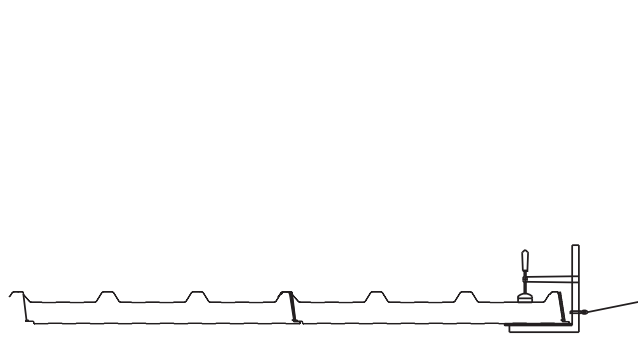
а. Этапы монтажа кровельных панелей. Опускание и сжатие соединения панелей.
